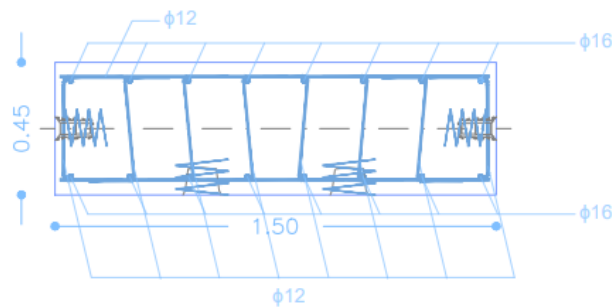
Plano Dovela – Armadura Sección Transversal – Dirección Longitudinal
